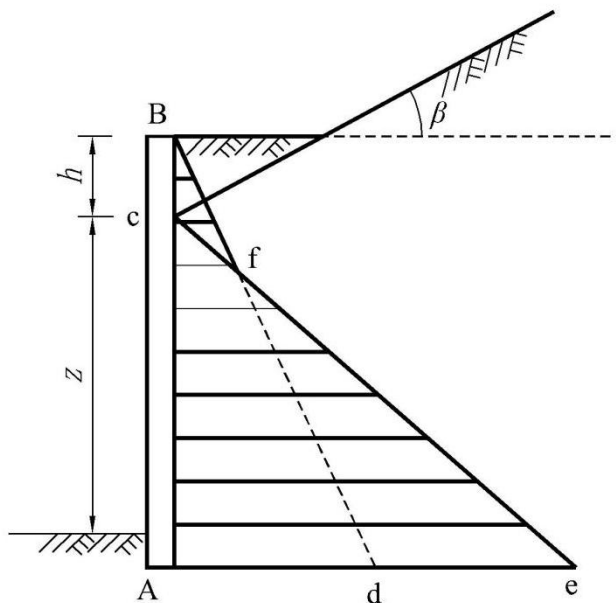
地面局部为水平时支护结构上主动土压力的近似计算
